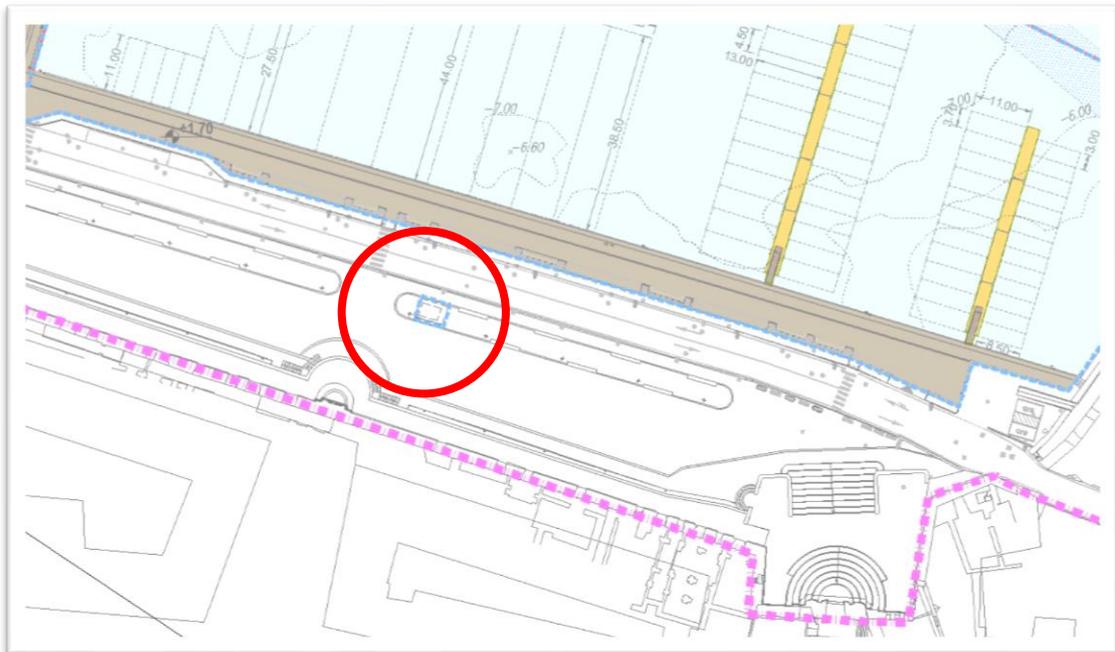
Planimetria ubicazione locale tecnico progetto definitivo
